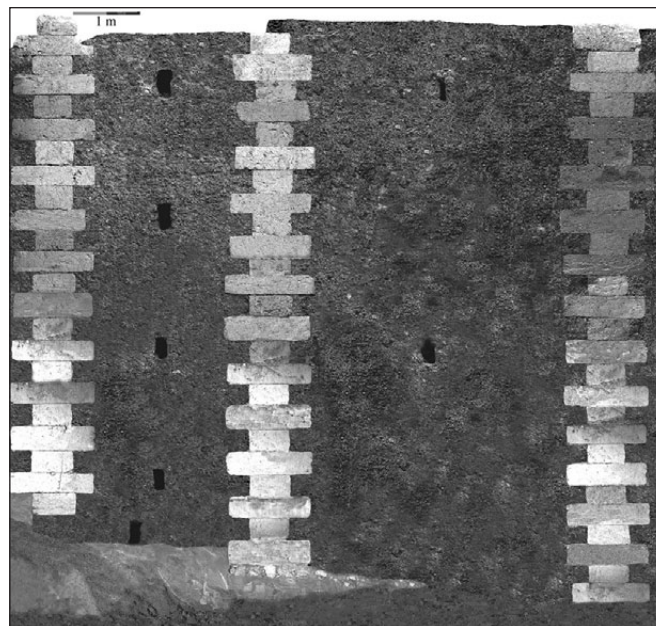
Le mur de soutènement de la falaise vu du nord (reconstitution d'après photomontage T. Maziers/Inrap).
